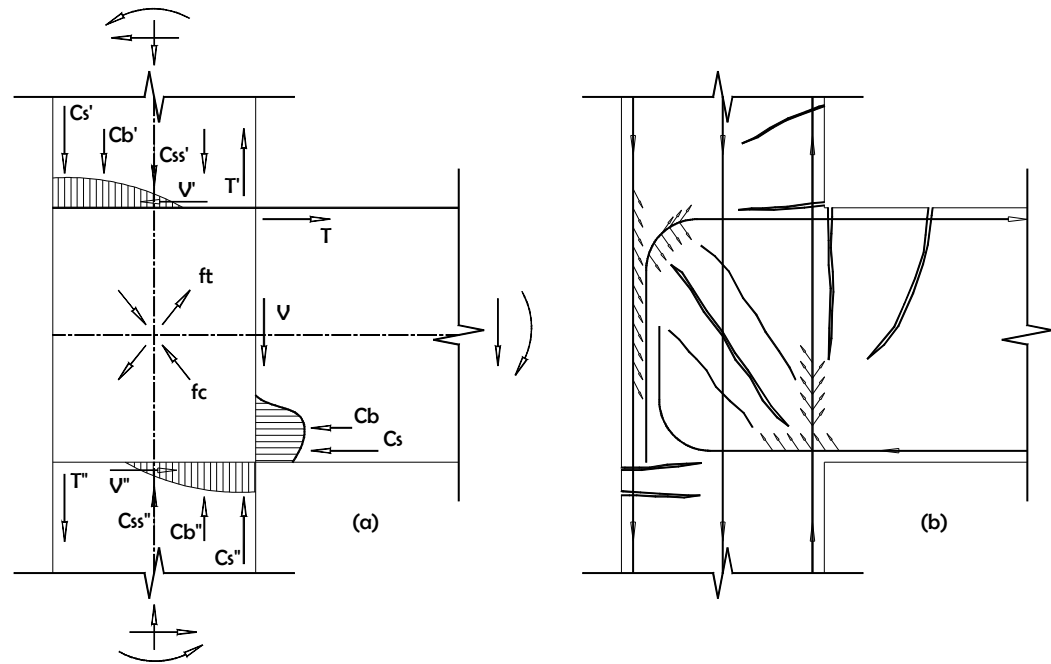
(a) Fuerzas actuantes – (b) Estado de fisuración.
